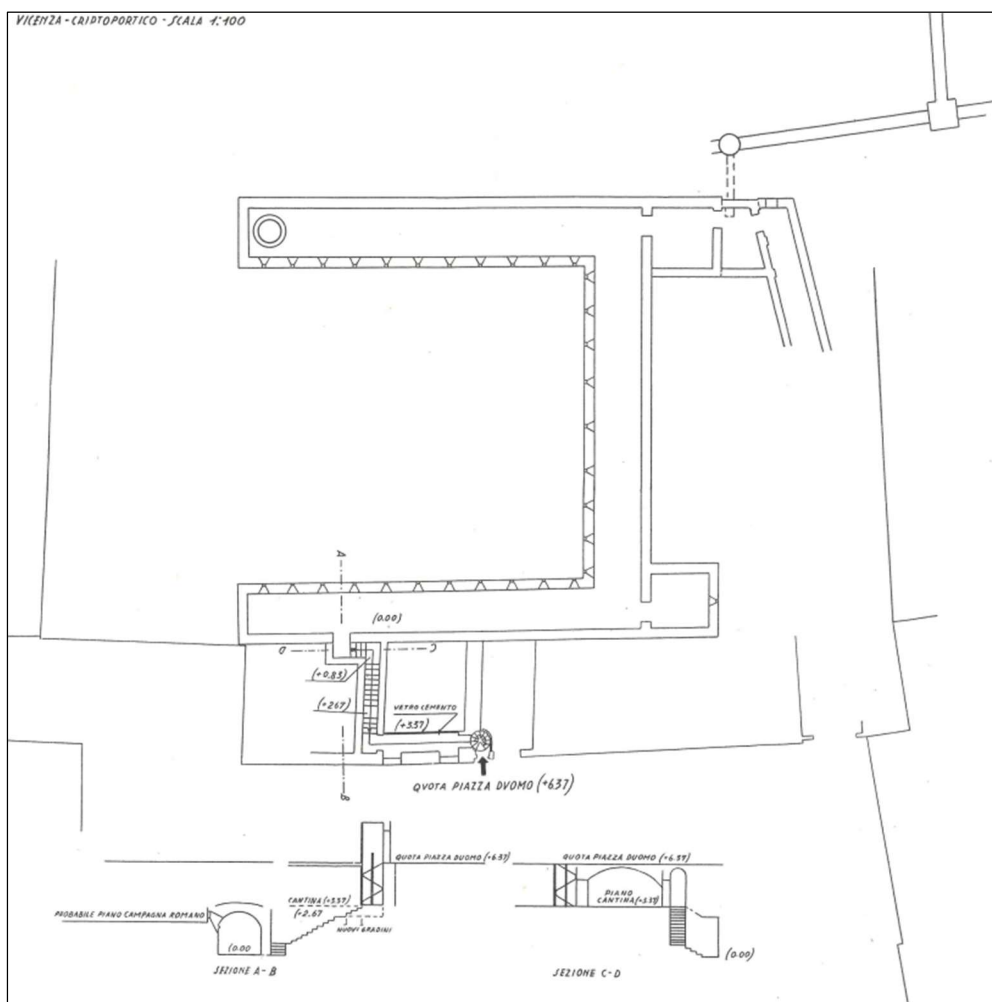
Planimetria del criptoportico. Fonte: FORLATI TAMARO 1958, tavola.
